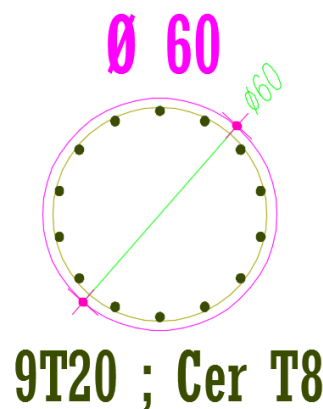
Ferraillage des poteaux P60 et P61 au sous-sol 1 et au RDC
